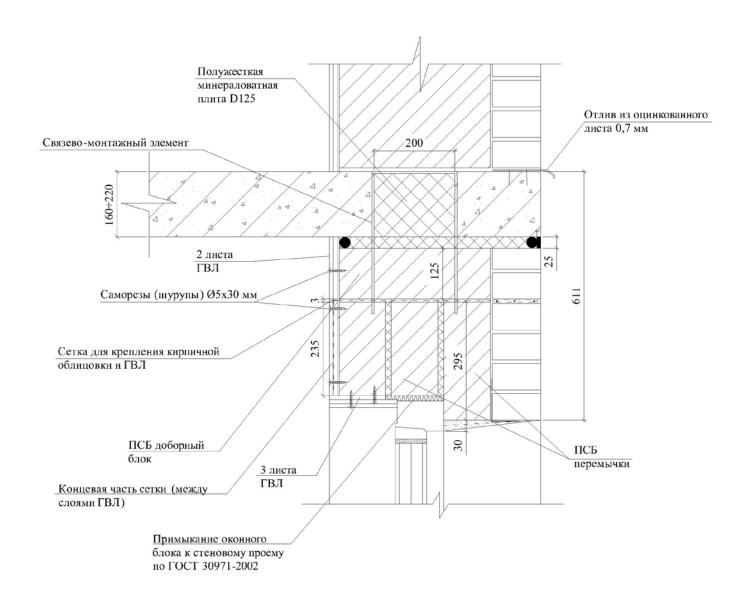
Крепление ГВЛ к кладке из ПСБ блоков с использованием штукатурной сетки
